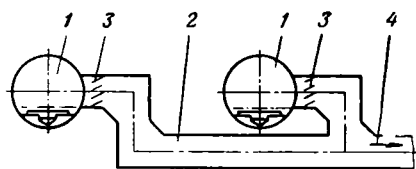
VIII. Схема примыкания вентиляционных тоннелей снизу к путевым перегонным тоннелям: 1 — перегонные путевые тоннели; 2 — вентиляционные тоннели; 3 — жалюзийные — многостворчатые регулировочные клапаны; 4 — к вентиляционной камере и шахте
